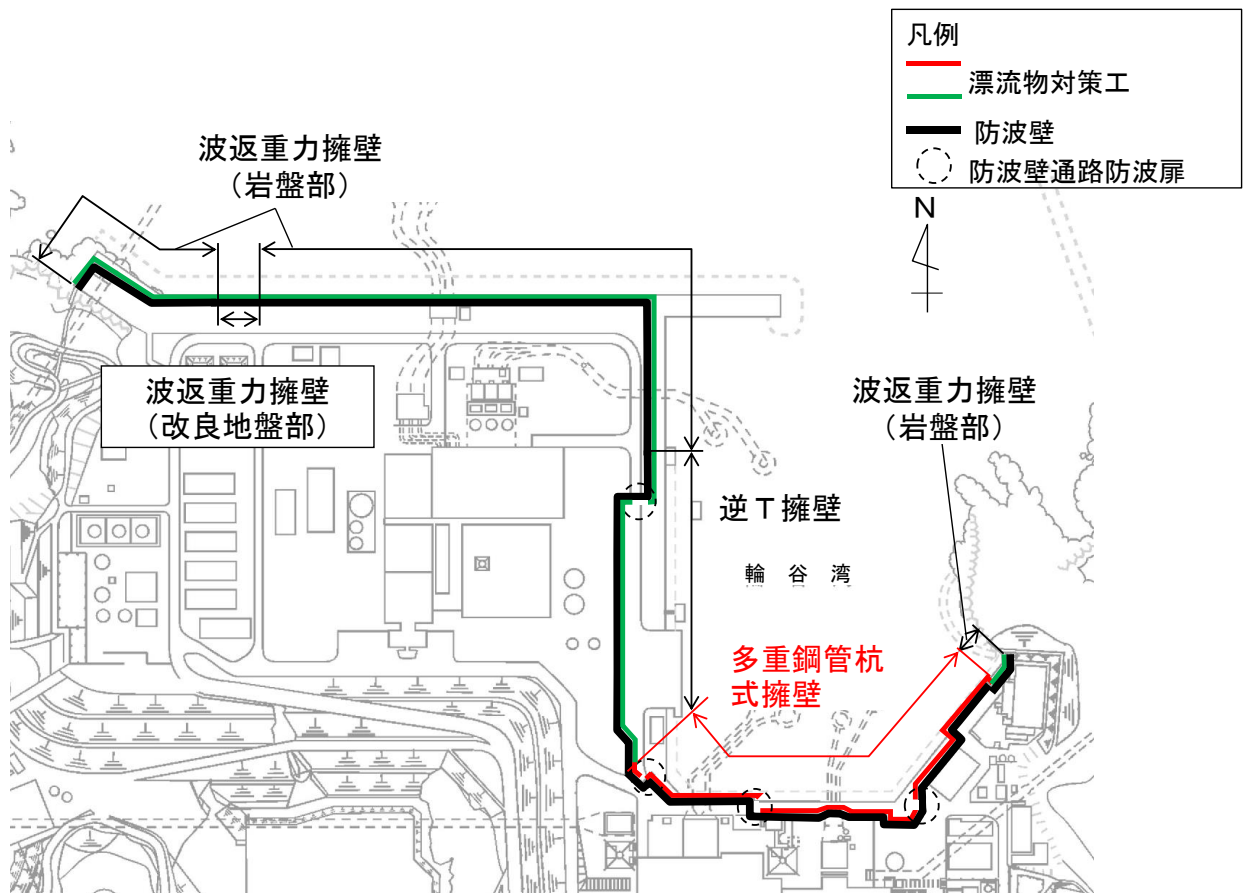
漂流物対策工（鉄筋コンクリート版）の位置図
